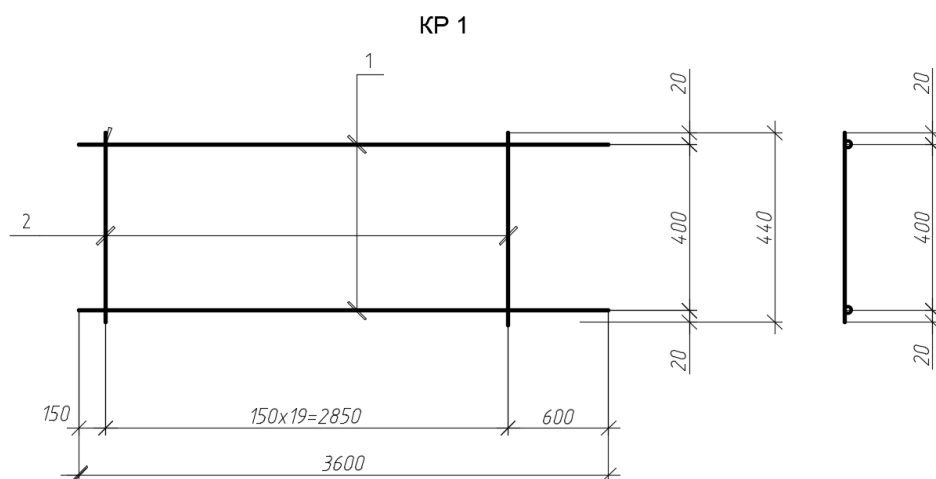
Армирование ростверка из забивных свай, КР 1
